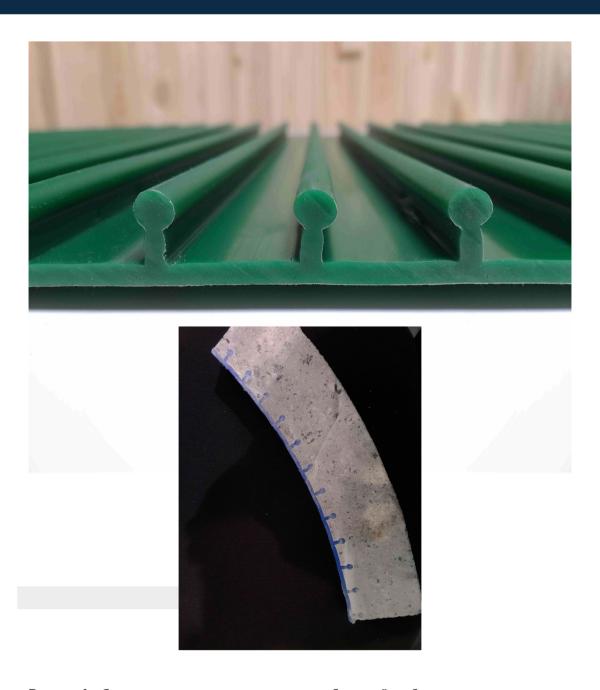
Соединение анкерного листа и железобетонной трубы
